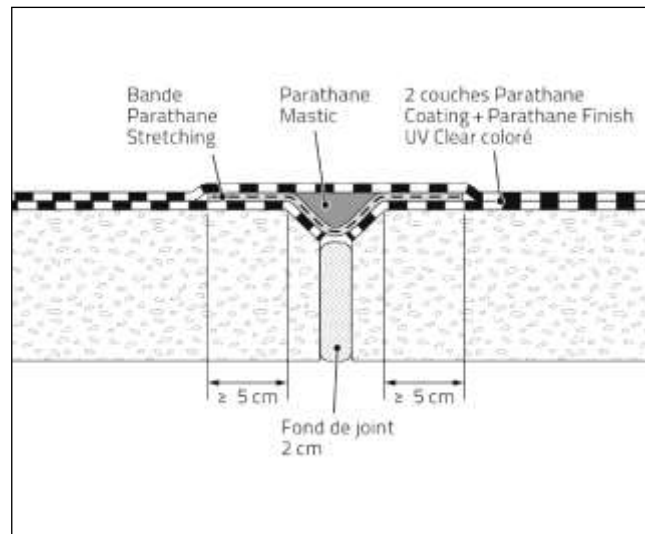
Joint de dilatation pour terrasse accessible hors dalles sur plots
